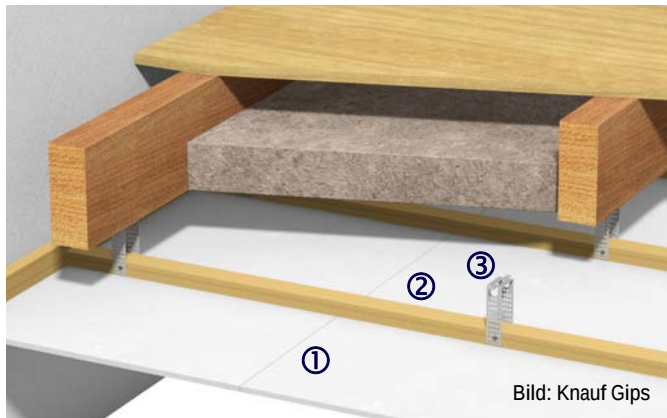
Holzbalkendecke mit einer Unterdecke aus Gipsplatten. Die Unterkonstruktion besteht aus Holzlatten, die mit Direktabhängern an der Balkenlage verankert sind.
